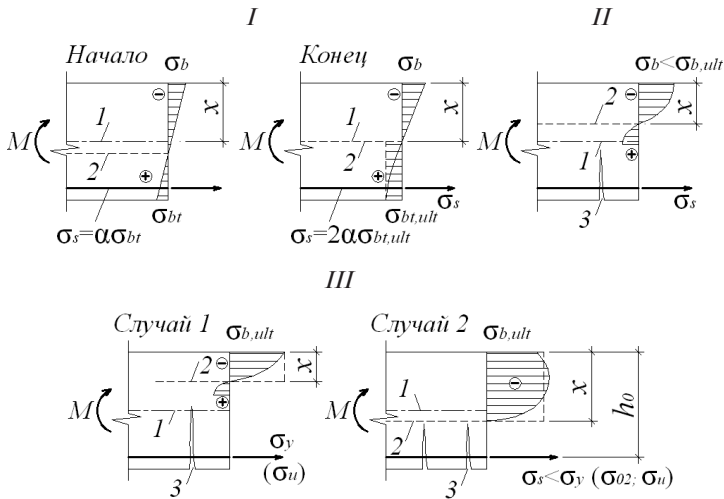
Стадии напряженно-деформированного состояния изгибаемого элемента без напрягаемой арматуры: 1 — центральная ось; 2 — нулевая линия; 3 — трещина
